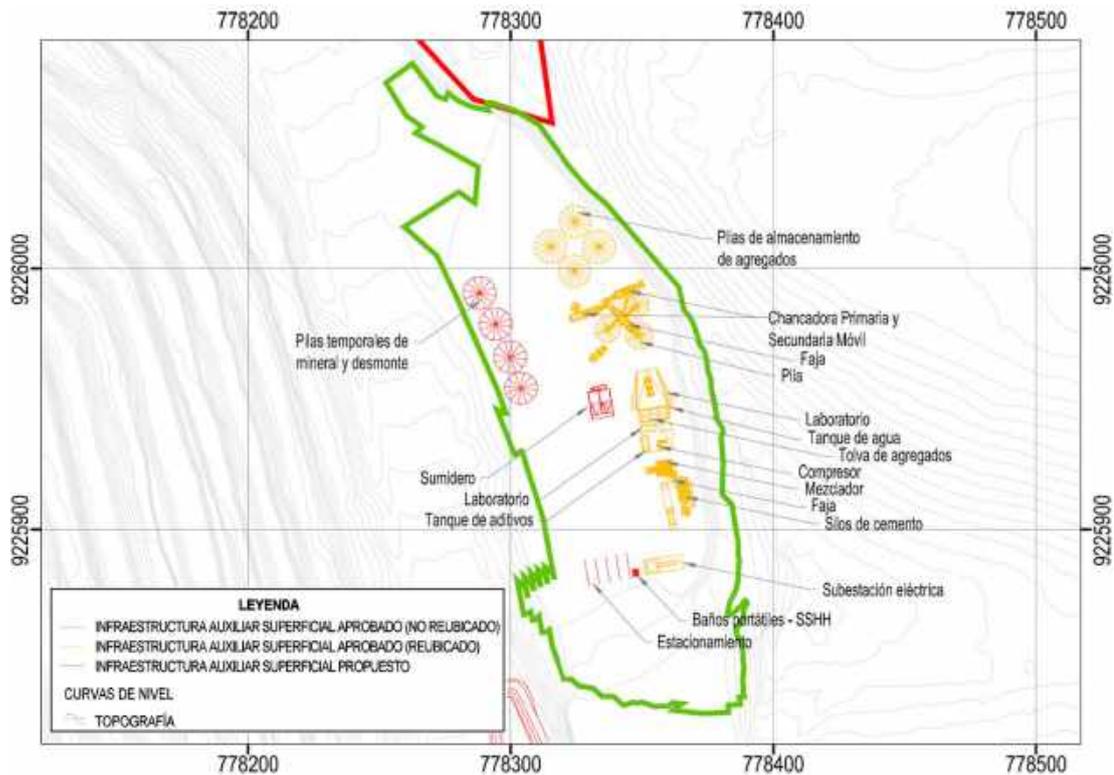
Segunda planta de relleno cementado, shotcrete y concreto, y planta de chancado y clasificación de agregados en el área 8
